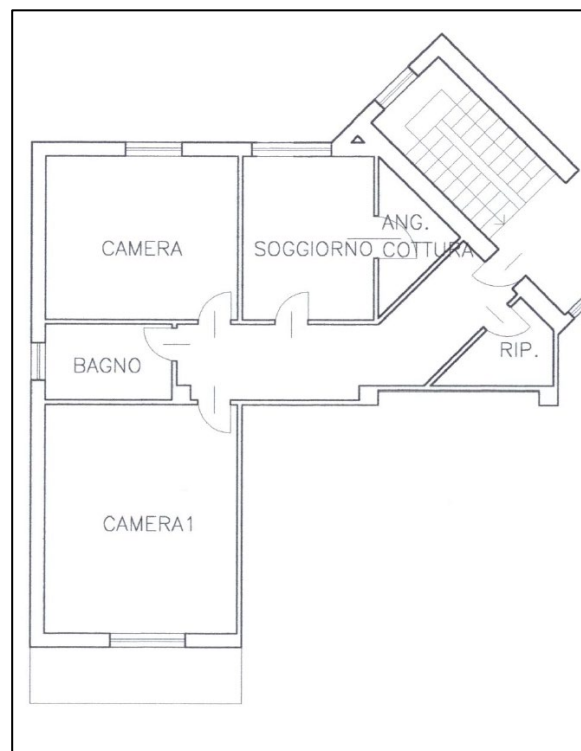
Stato di fatto dell'u.i. dall'art. 26 del 2001
